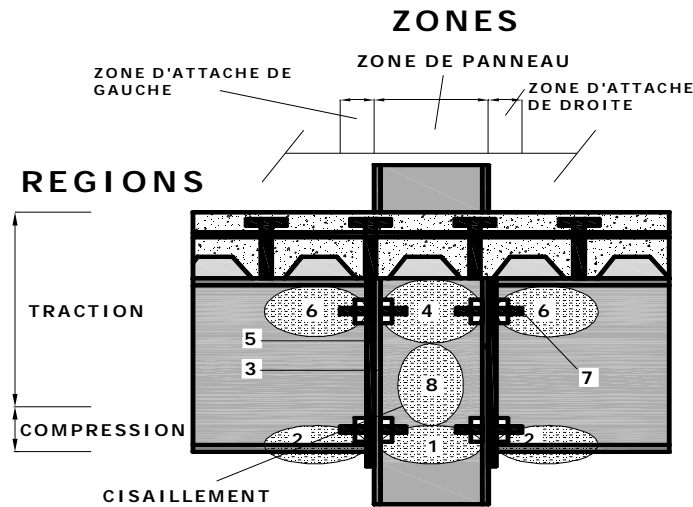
régions et zones d'un assemblage mixte poutre-poteau.
